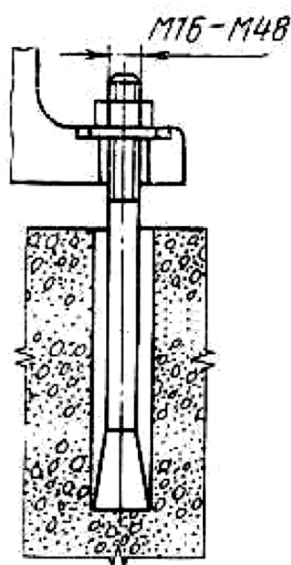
Глухий конічний фундаментний болт, що встановлюється в готові фундаменти з зачеканенням цементним розчином
